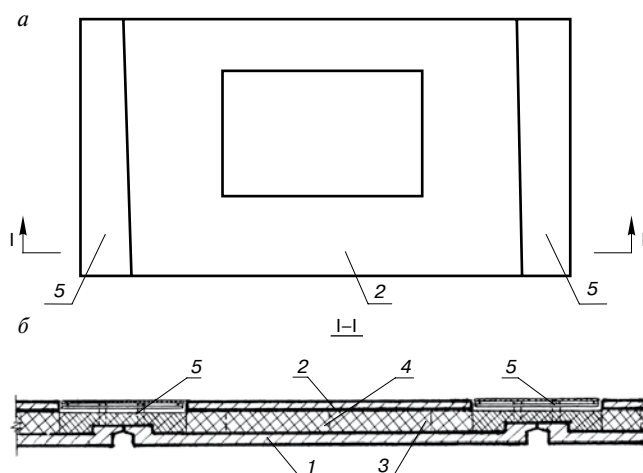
Комбинированная наружная стеновая панель: а – общий вид; б – продольное сечение I–I комбинированной наружной стеновой панели; 1 – внутренний несущий железобетонный слой; 2 – защитный наружный железобетонный слой; 3 – теплоизоляционный слой; 4 – связи между внутренним и наружным слоями; 5 – навесной фасад
